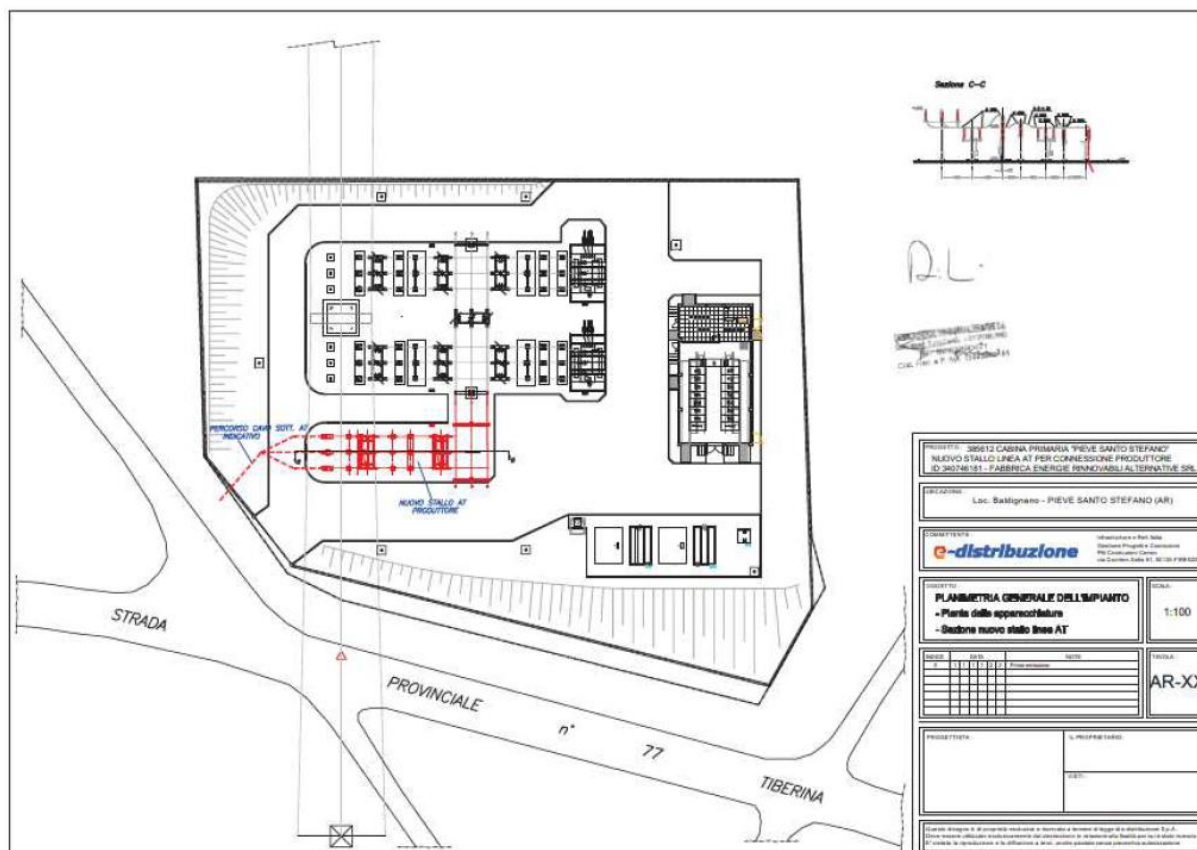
Estratto STMG - indicazione del punto di allaccio dell'impianto eolico mediante cavo AT all'impianto di Rete
